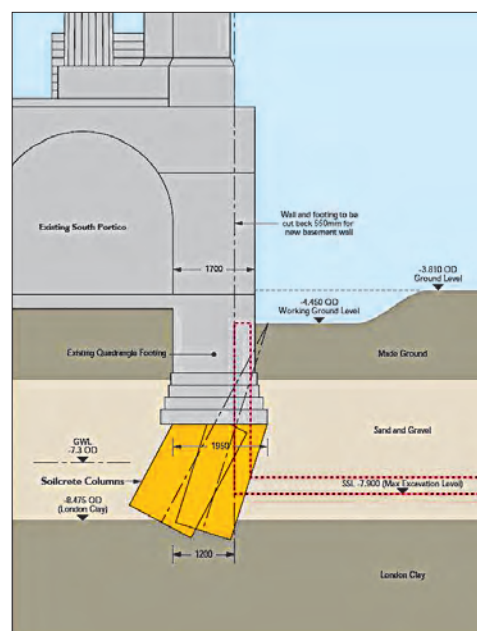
RECALCE CON JET-GROUTING DESDE UN SOLO LADO.
